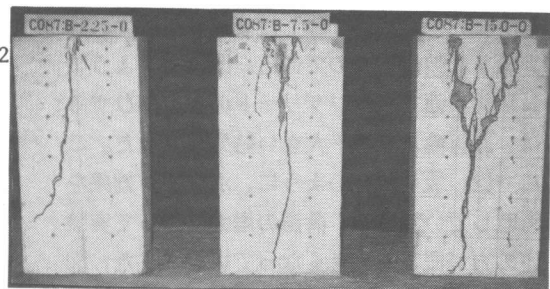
破壊試験後のひびわれ様相 (鉄筋のない試験体)
